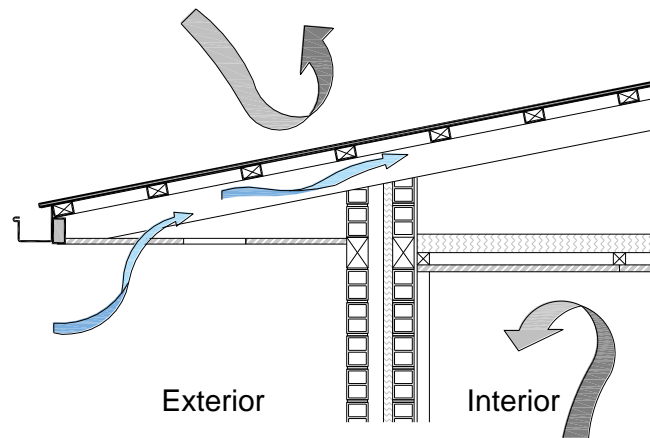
Detalle constructivo de la cubierta y aislamiento térmico
